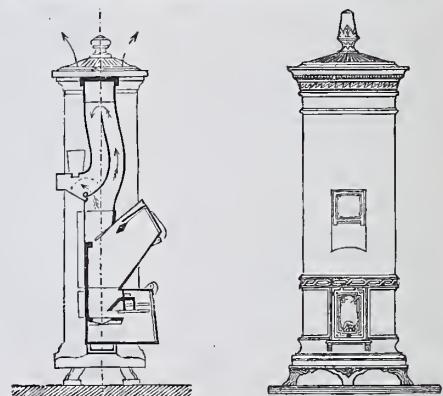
u. Fig. 2723. Käufers Schachtofen mit Mantel.
